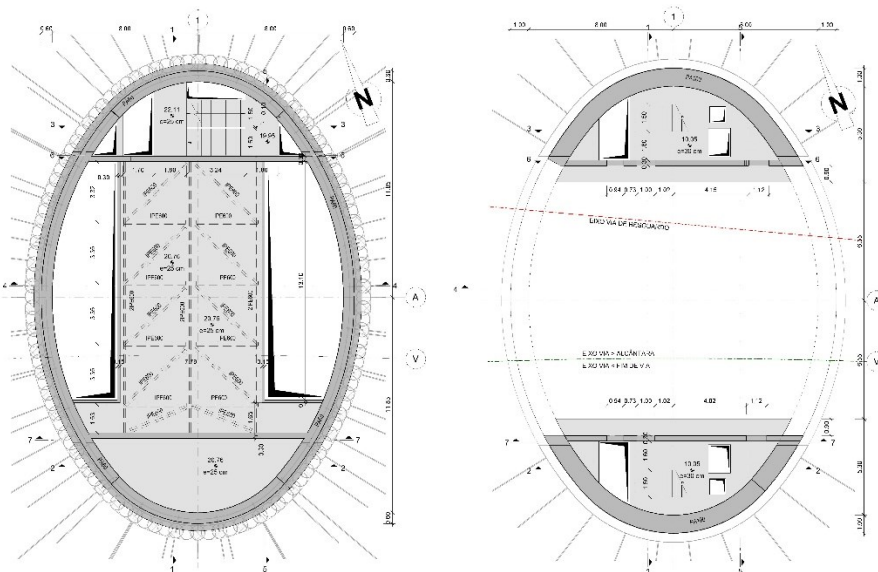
Plantas tipo da estrutura definitiva do poço
